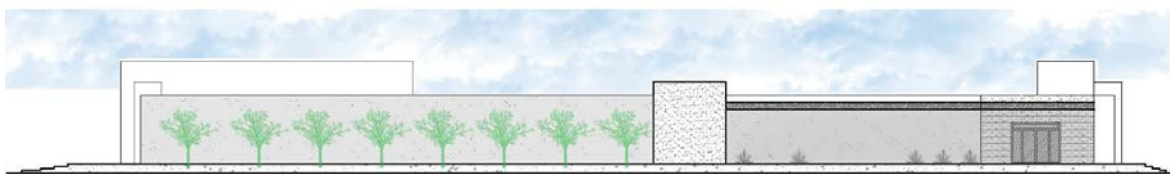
Elevación poniente. Fuente propia. Sin escala.
